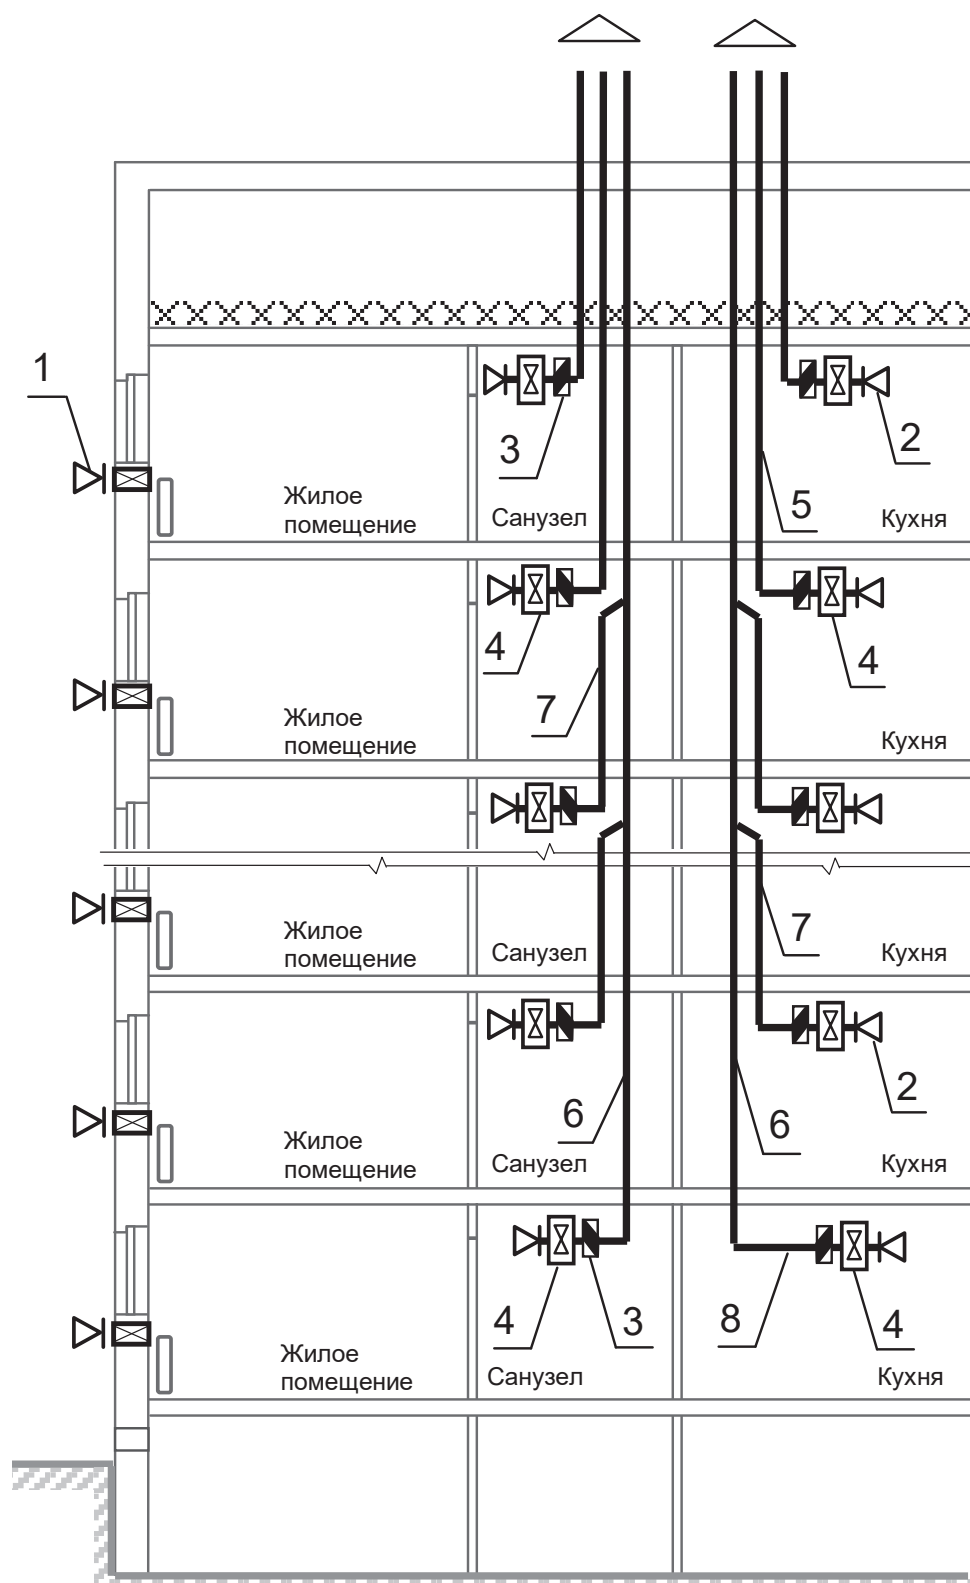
Принципиальная схема системы вентиляции жилых зданий с децентрализованным механическим удалением воздуха посредством индивидуальных вытяжных вентиляторов:
